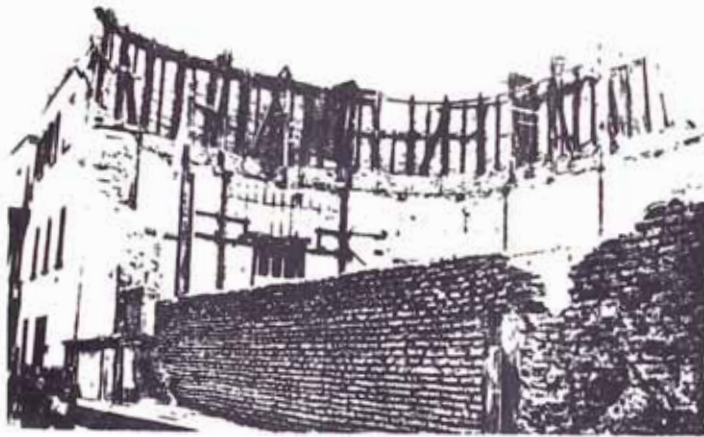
Nuevamente viviendas en la zona 6, pero aquí se aprecia el suelo muy agrietado y deformado.
